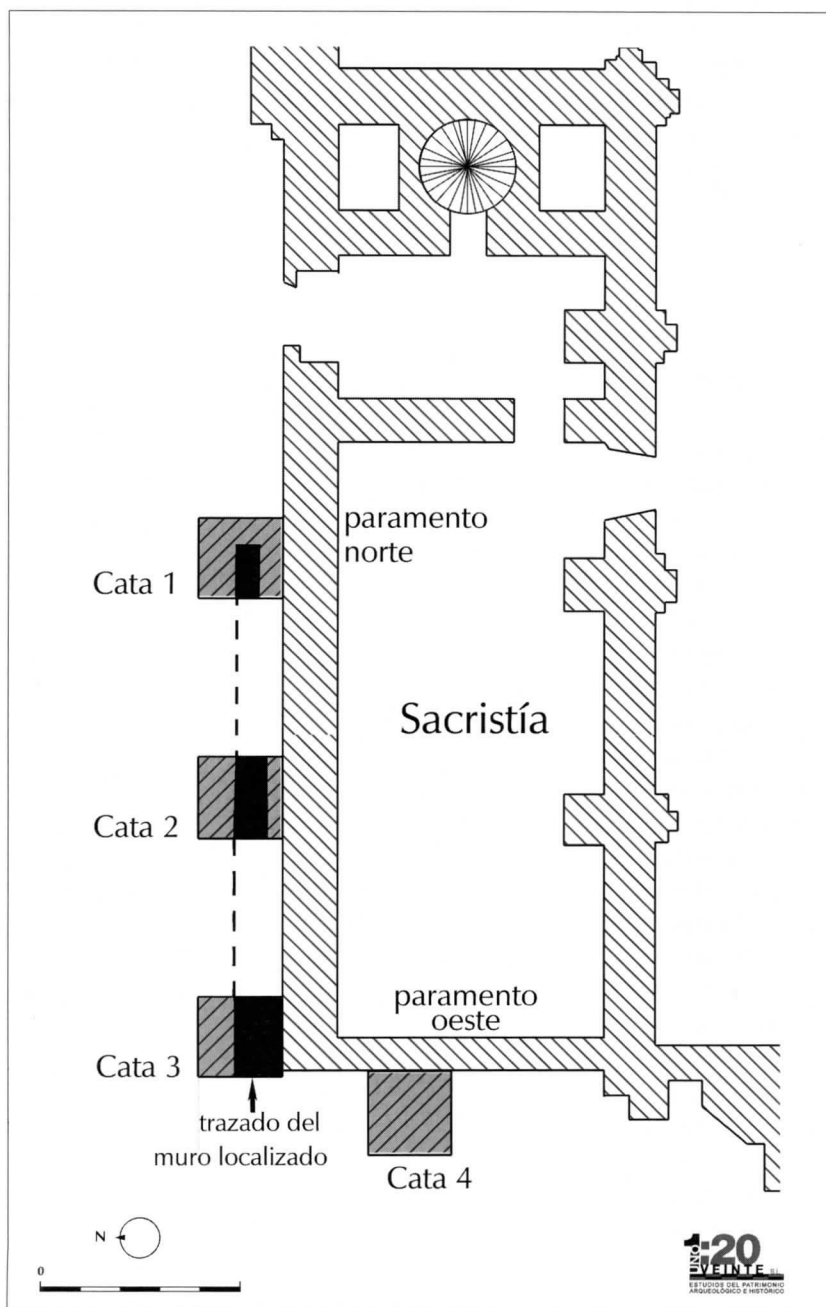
Planta de la sacristía con las catas y la prolongación del muro localizado en la excavación
